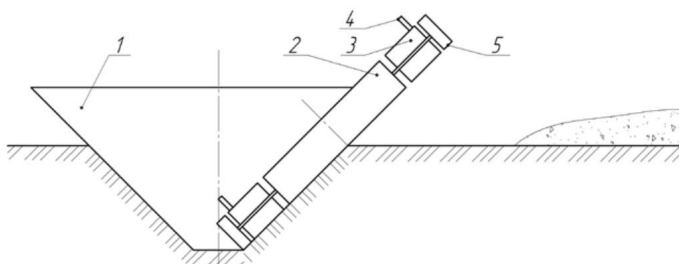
Схема плужно-фрезерного (плужно-ротаторного) рабочего органа: 1 – плуг; 2 – фреза; 3 – лопатки; 4 – рушители; 5 – ножи
